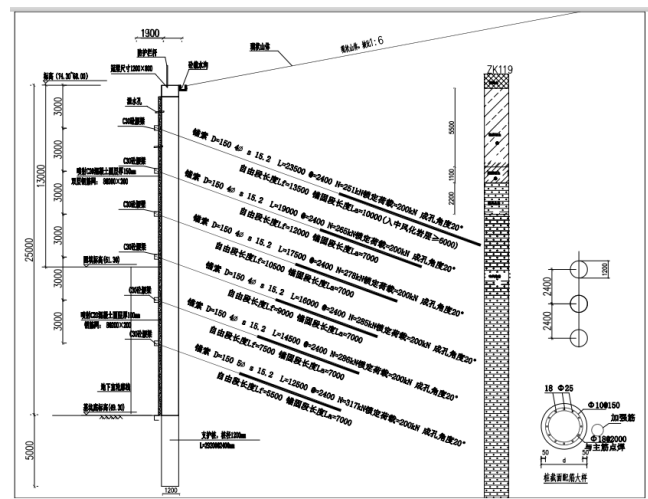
基坑边坡 EG 段柔性预应力锚索支护剖面图
